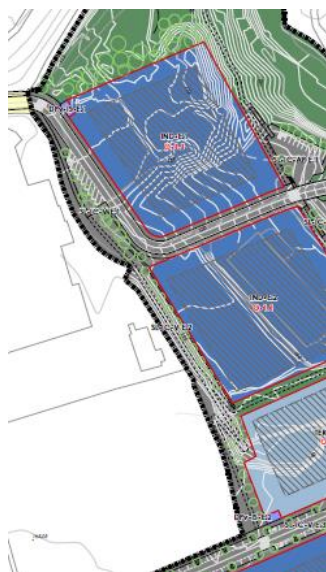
Planta de propuesta de detalle de la zona expuesta
